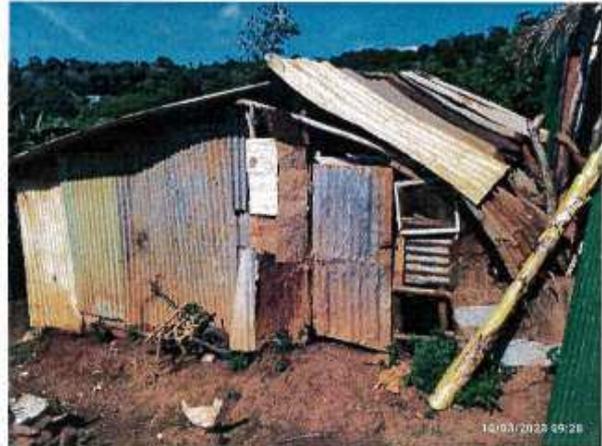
construction formée par assemblage de matériaux hétéroclites en mauvais état
